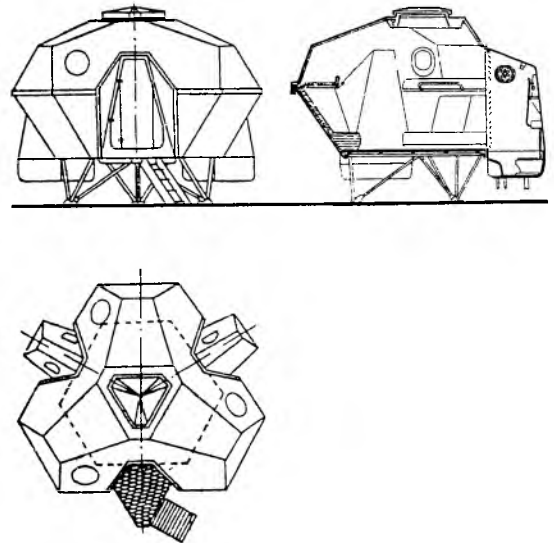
Пересувний житловий будинок, арх. М. Курокава, 1970 р. Фасад, розріз, план
